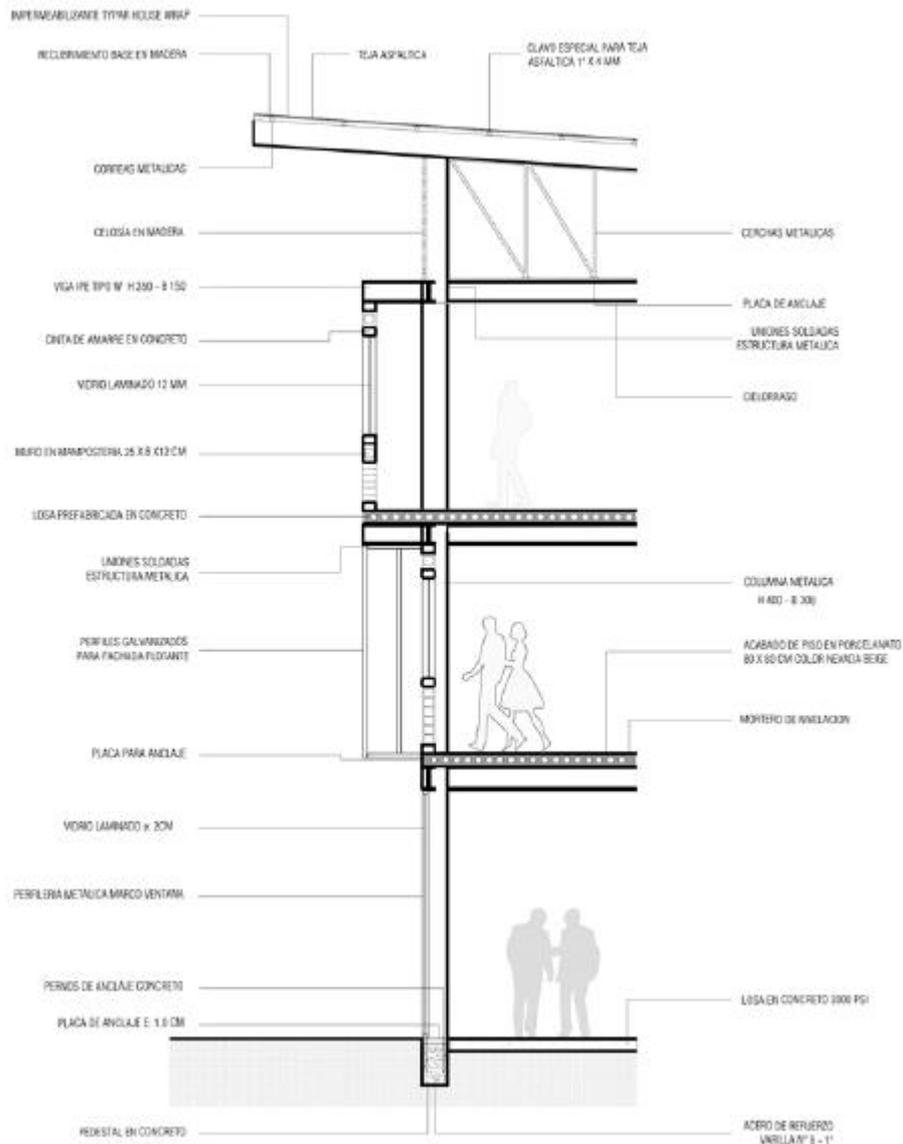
Detalle corte fachada Fuente: Elaboración propia
